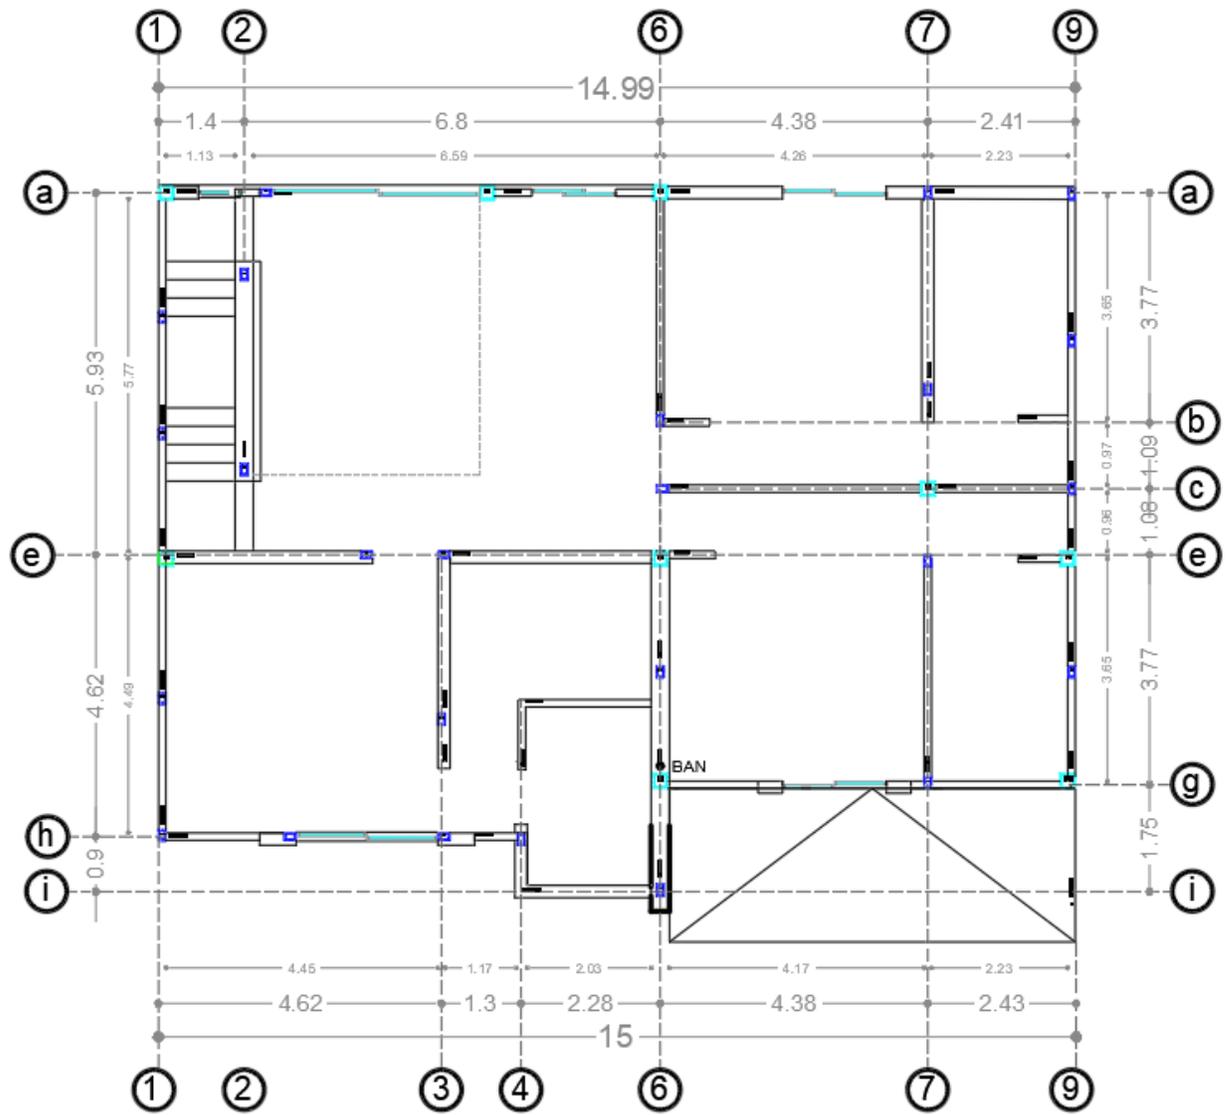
Planos Planta alta columnas, castillos (Muciño, 2022)
